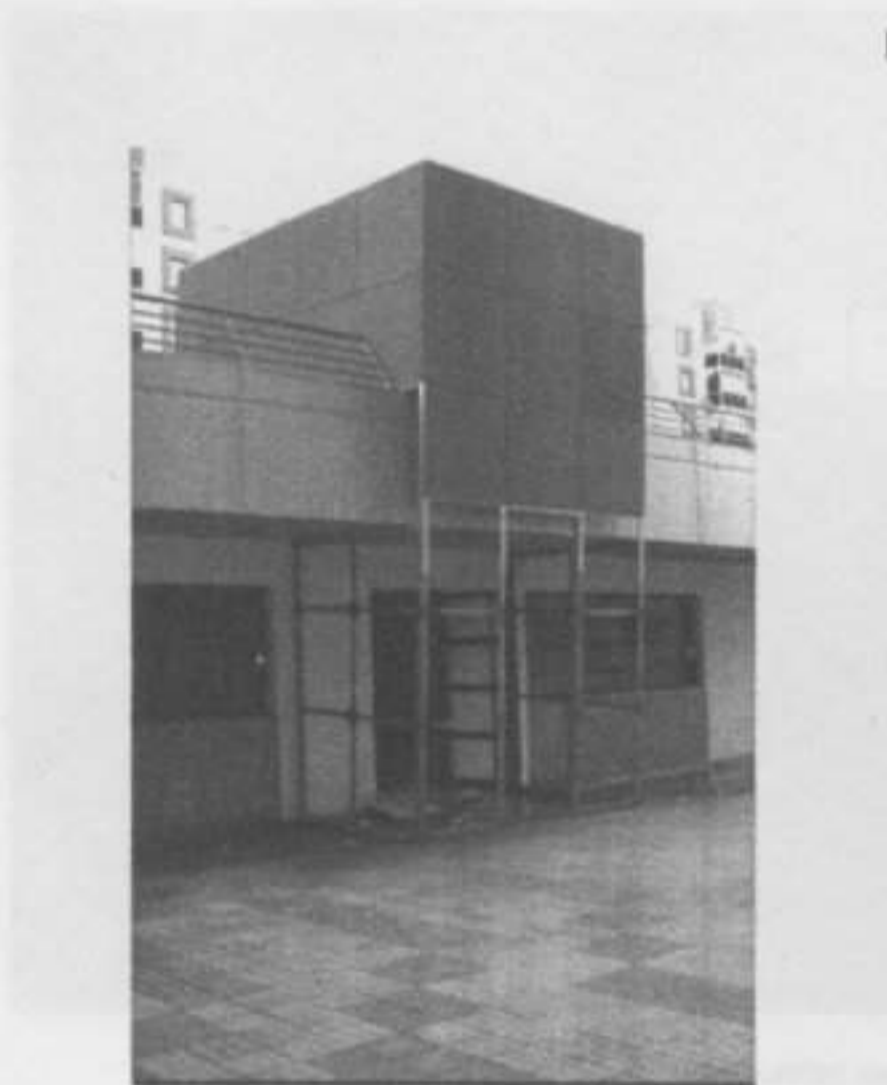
Estrutura metálica sobre os aparelhos de AVAC, 1ª fase
